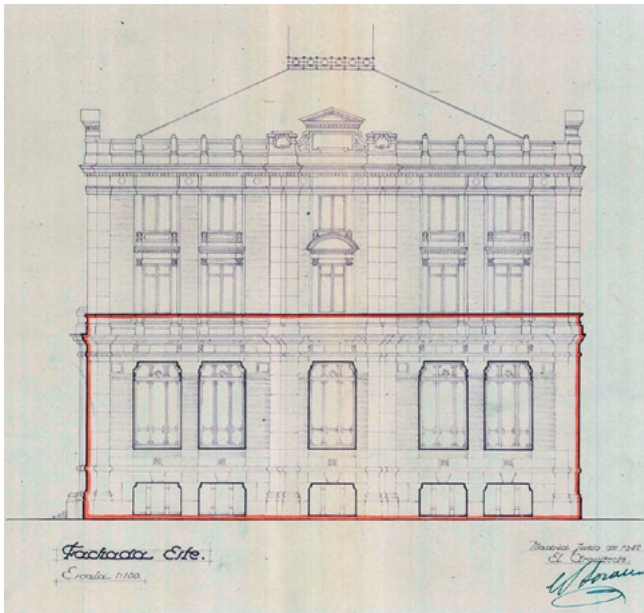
Proyecto de reconstrucción de la Escuela de Agrónomos. Fachada este. Eugenio Sánchez Lozano, 1942. Fuente: AGA. Fondo Ministerio de Educación, IDD (05)001.008.002, Caja 32/17243.
